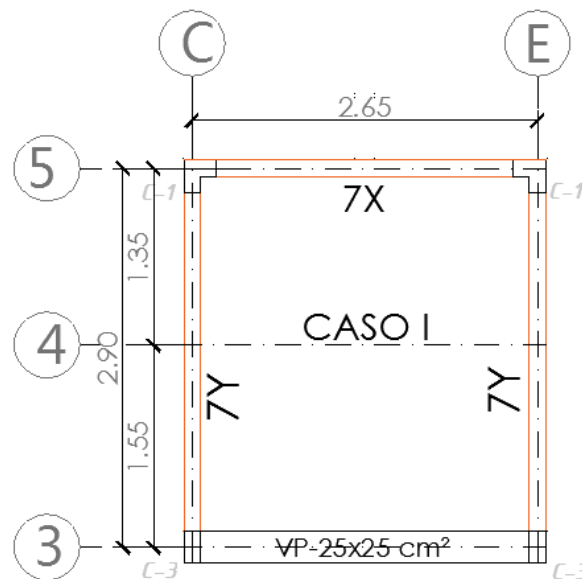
Planta de paño de losa maciza según caso (Fuente: Elaboración propia).
